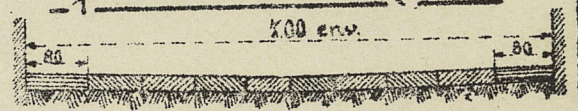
Pavage à joints d'asphalte sur fondation en béton (Schéma)
